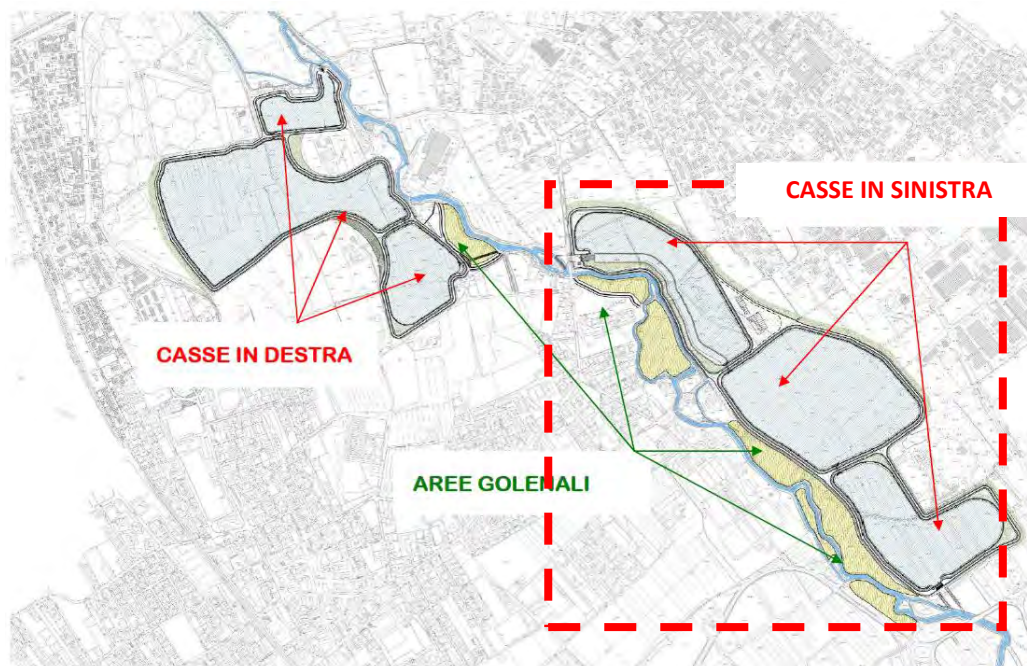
Planimetria degli interventi sul Fiume Olona.
